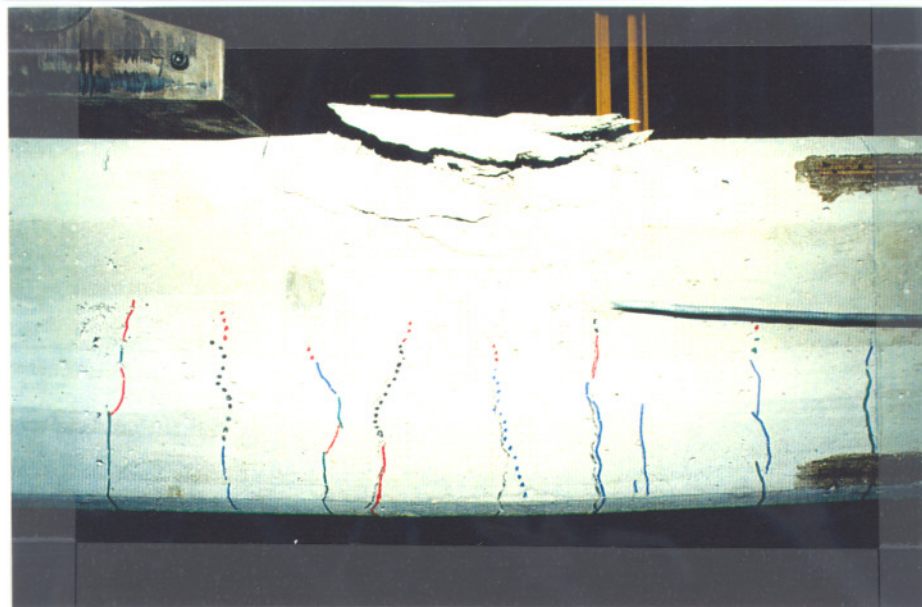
En todas las vigas de la primera serie se produjo el pandeo de la armadura superior (de montaje), con el consiguiente desconchamiento del hormigón. (viga R13)
